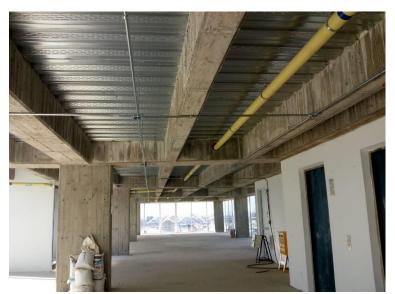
Entrega de pisos en obra negra para instalación de sistema de cableado estructurado
